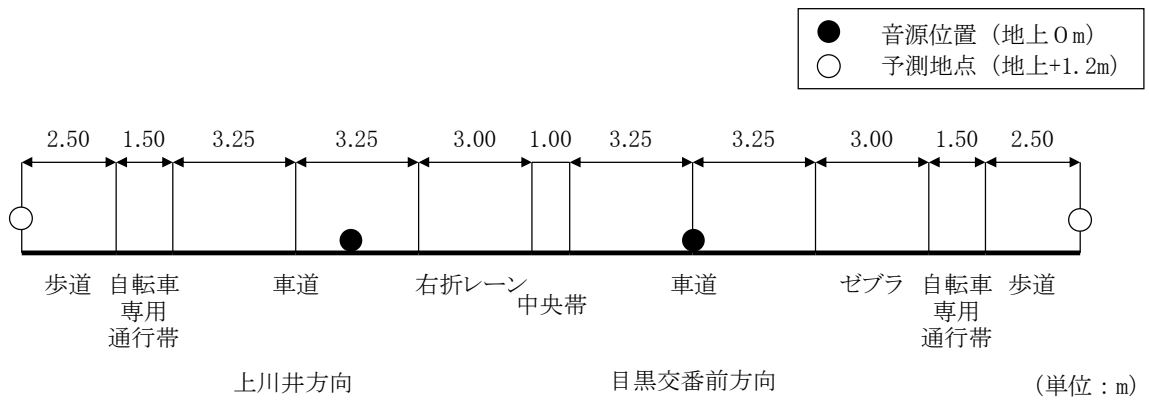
(3) 道路断面及び音源の位置 (No. 3)
